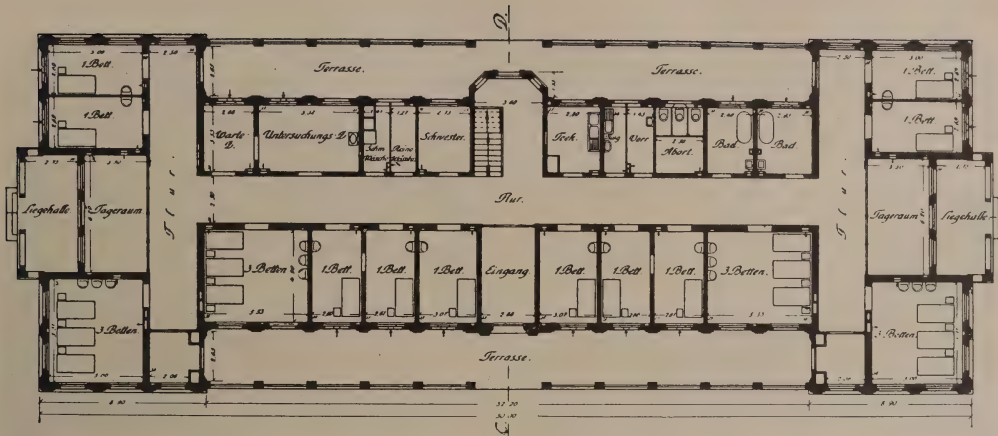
Grundriß eines Kleinzimmerpavillons (früher Kostgängerhaus)
